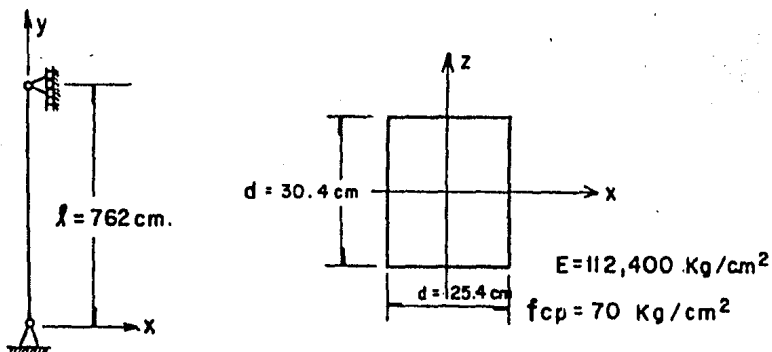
Columna con sistema de apoyo igual para ambos planos.
